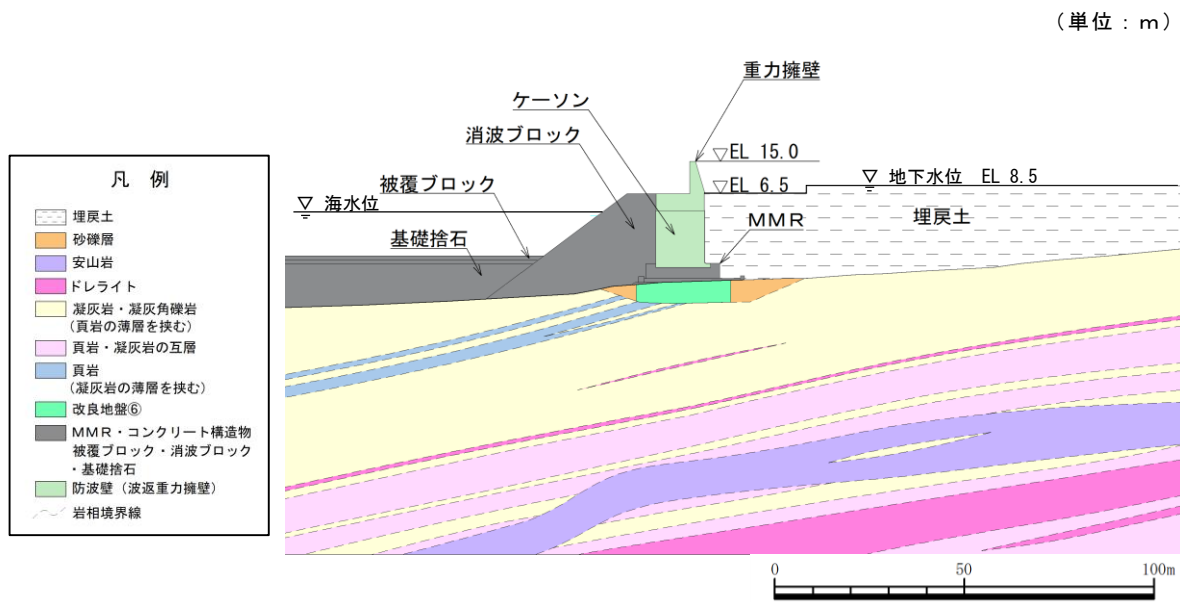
防波壁 (波返重力擁壁) の横断面図 (②-②断面)
